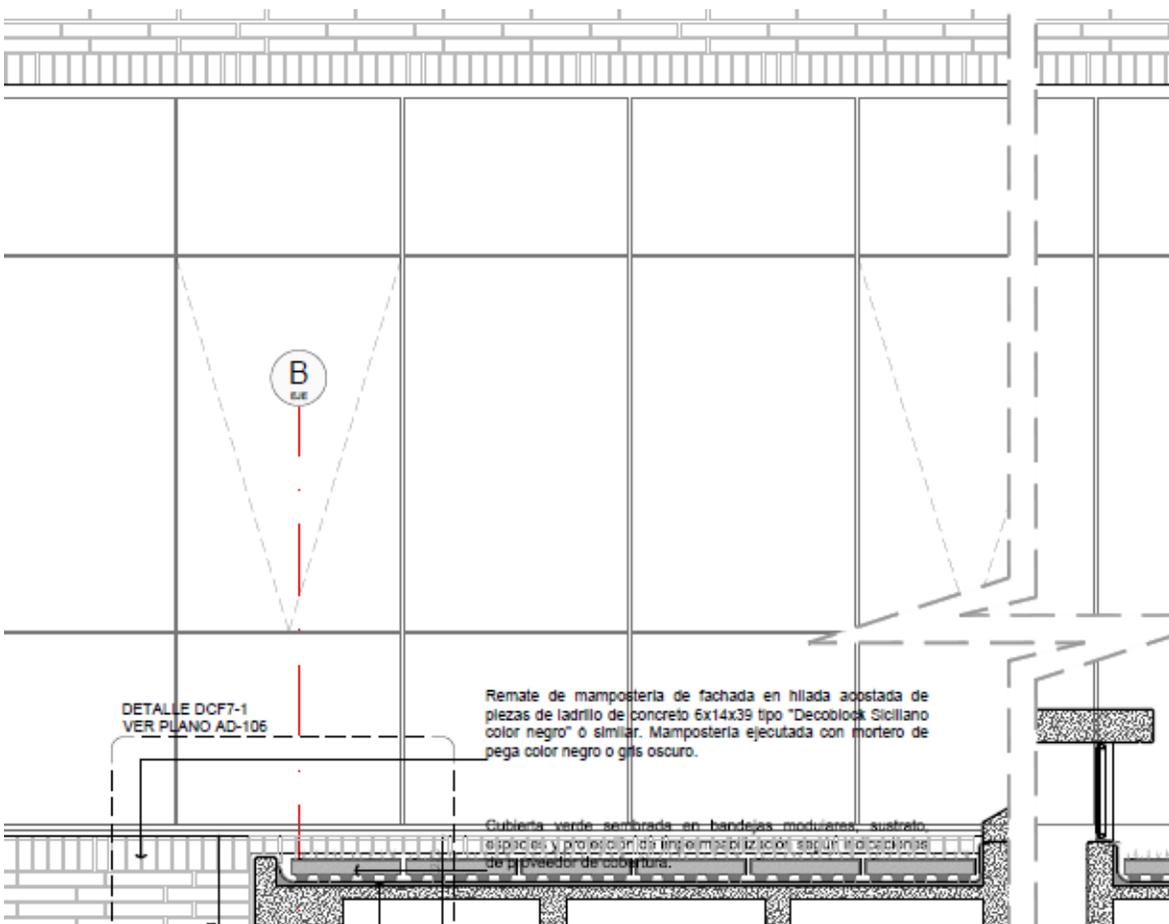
Localización aperturas en fachada sur A-302 Anexos
